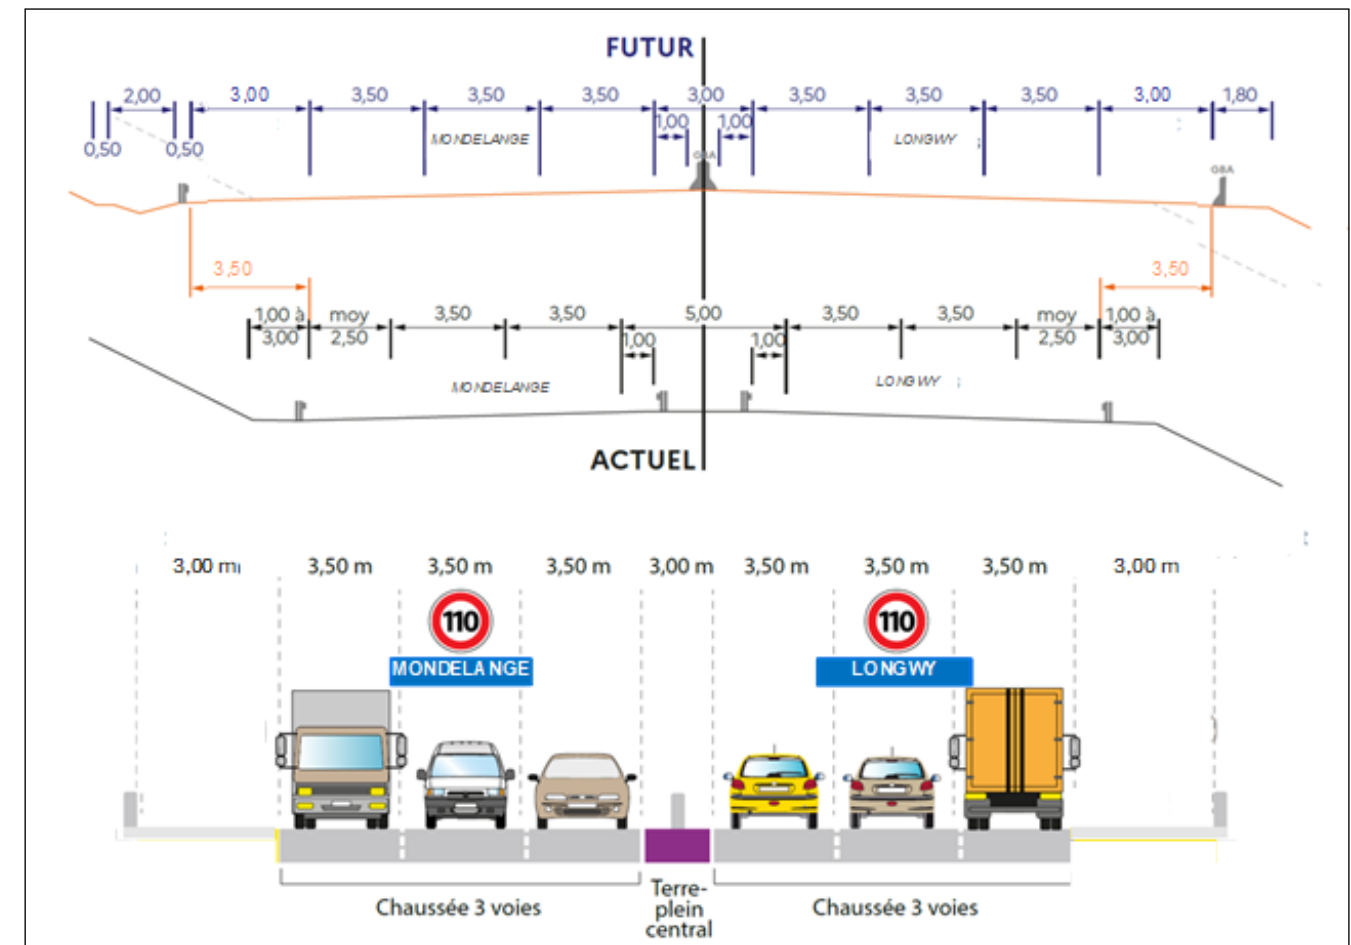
Profil en travers schématique de l'élargissement de l'autoroute A30 entre Fameck et Richemont
